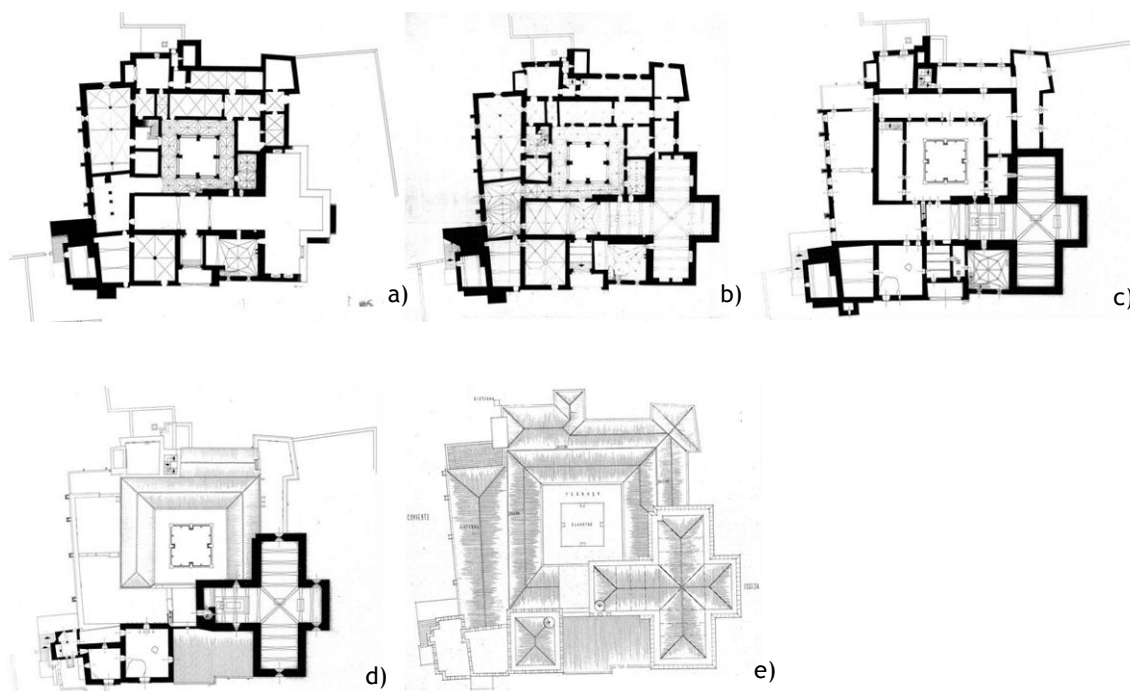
Plantas depois das obras de restauro da DGEMN, a) piso do R/C; b) piso 1; c) piso 2; d) piso 3; e) cobertura.
